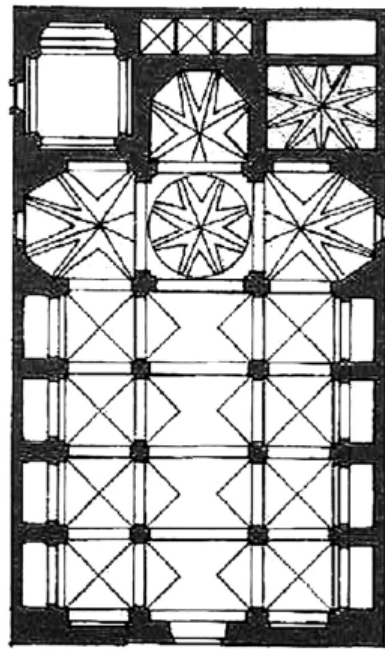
Villarreal (Castellón). Arciprestal de San Jaime. Planta. Autor: Arturo Zaragoza.
